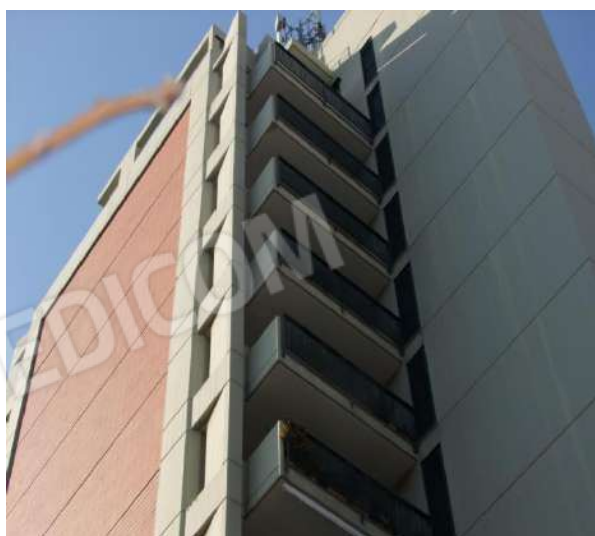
Vista angolare dell'edificio dalla viabilità laterale, particolare piano 9°
